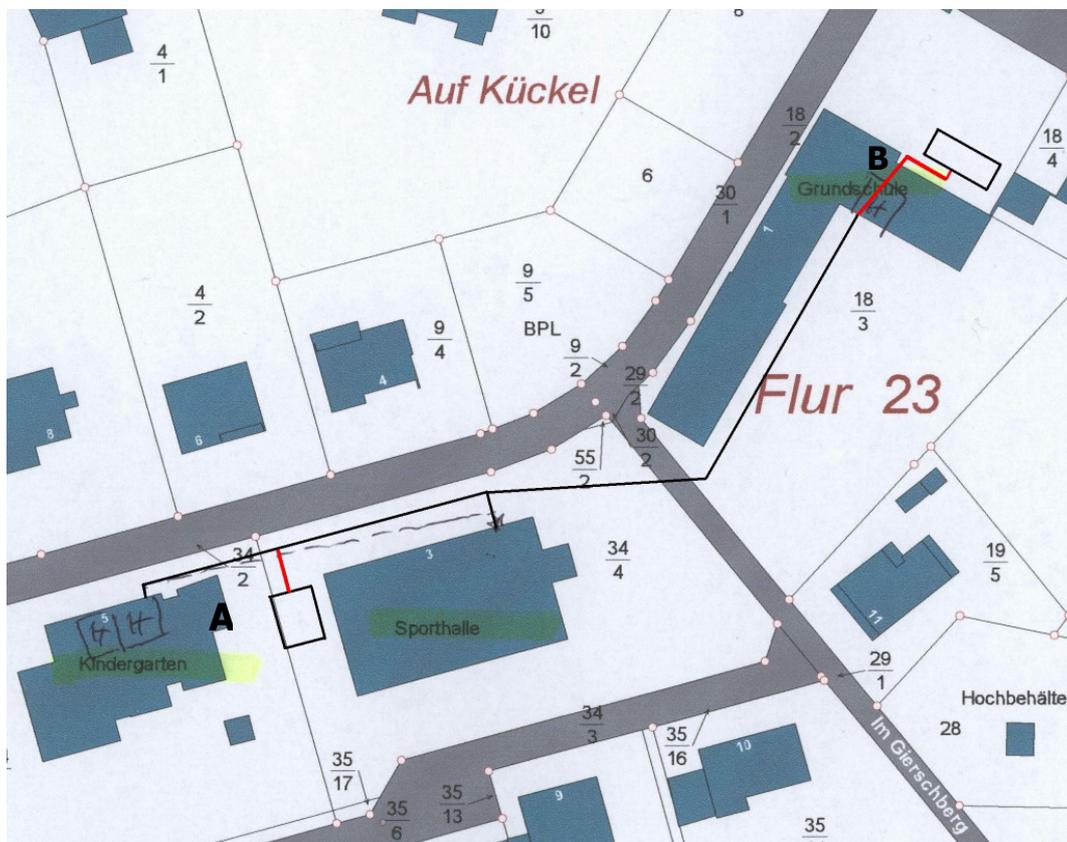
Lageplan mit Leitungen und möglichen Standorten der Heizzentrale
